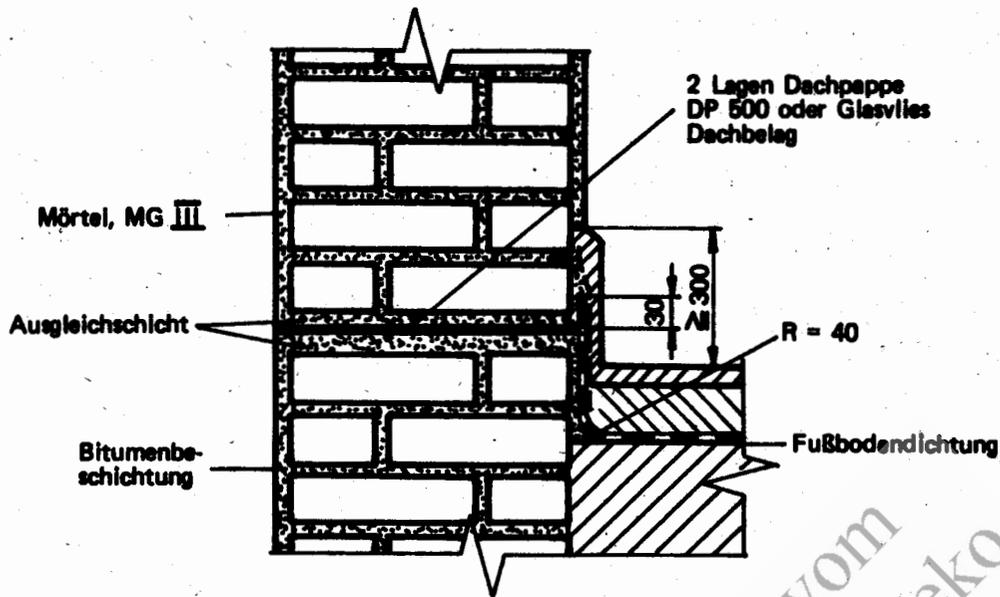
Waagerechte Wanddichtung dargestellt in Mauerwerk mit Anschluß an Fußbodendichtung
